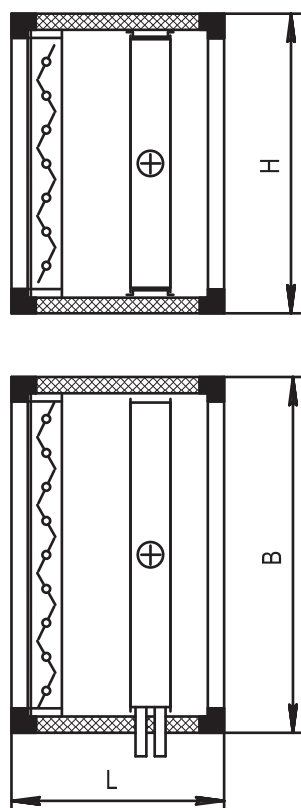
Габаритные размеры моноблока состоящего из клапана и воздушонагревателя гликолевого
